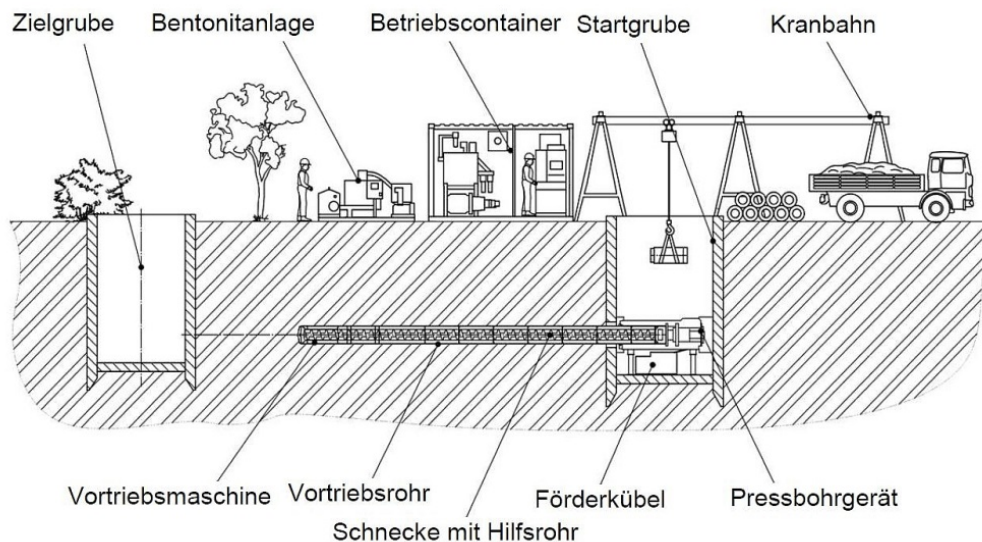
Beispiel Mikrotunnelbau mit Schneckenförderung, Quelle: DWA 2008
